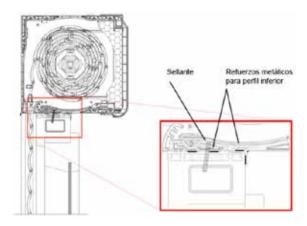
Detalle de unión de carpintería a cajón de persiana mediante tornillería y cajón con refuerzos metálicos para perfil inferior
